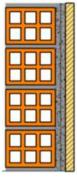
Esquema representativo del ladrillo Cerámico hueco, Aislante y placa de yeso - Fuente: Empresa ekoteknia.[13]
